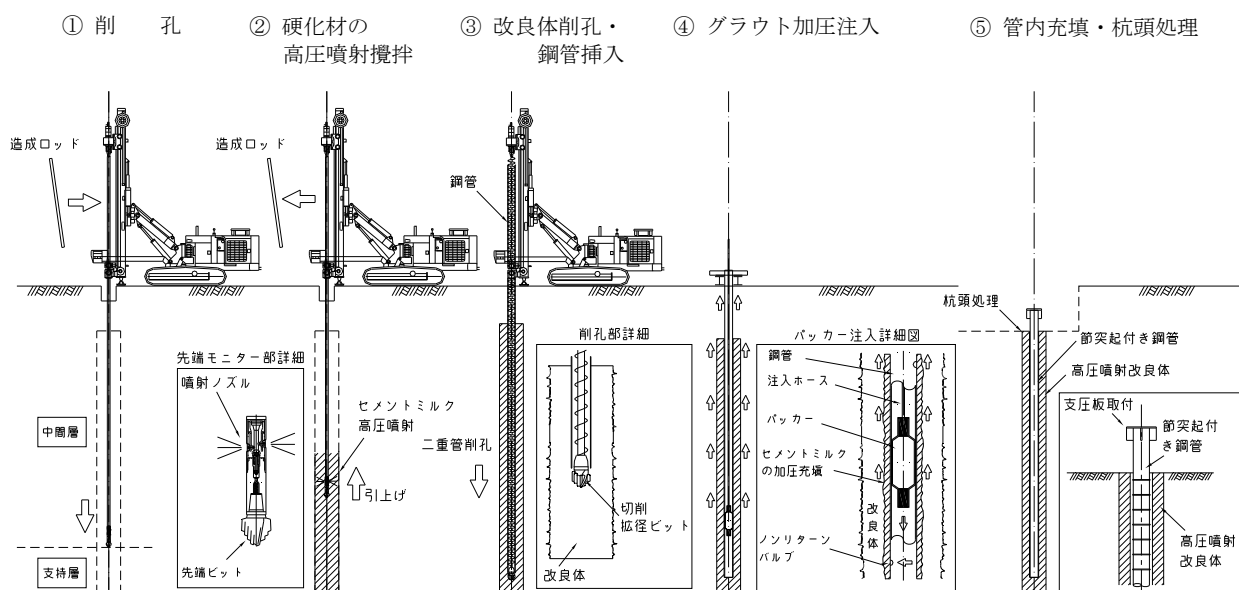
STMP タイプⅡ（改良体二重管削孔方式）の施工図
